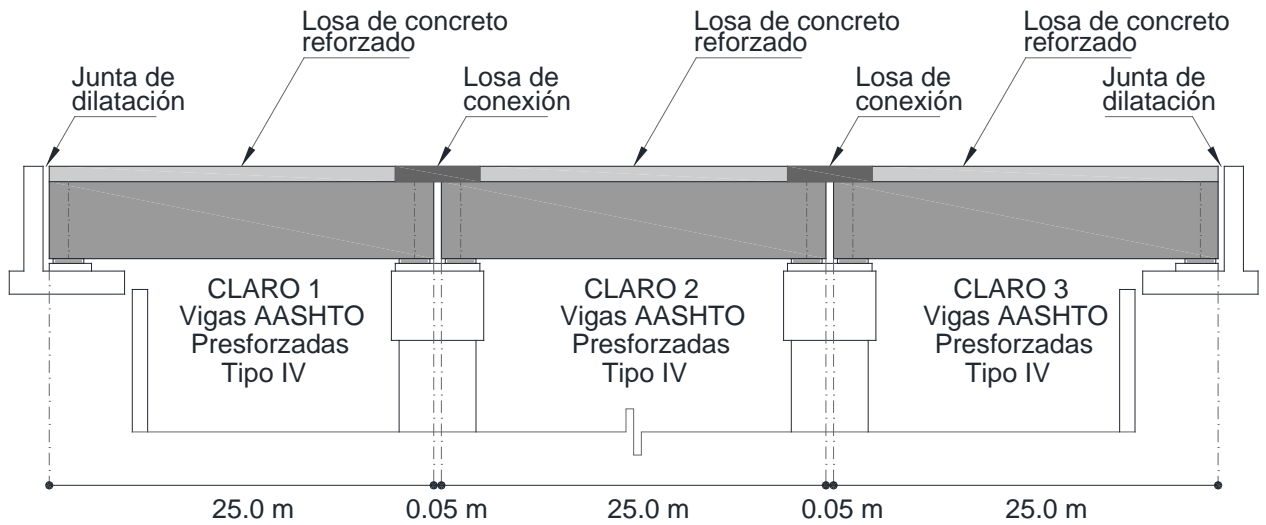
Corte longitudinal del Puente con losas de conexión.
